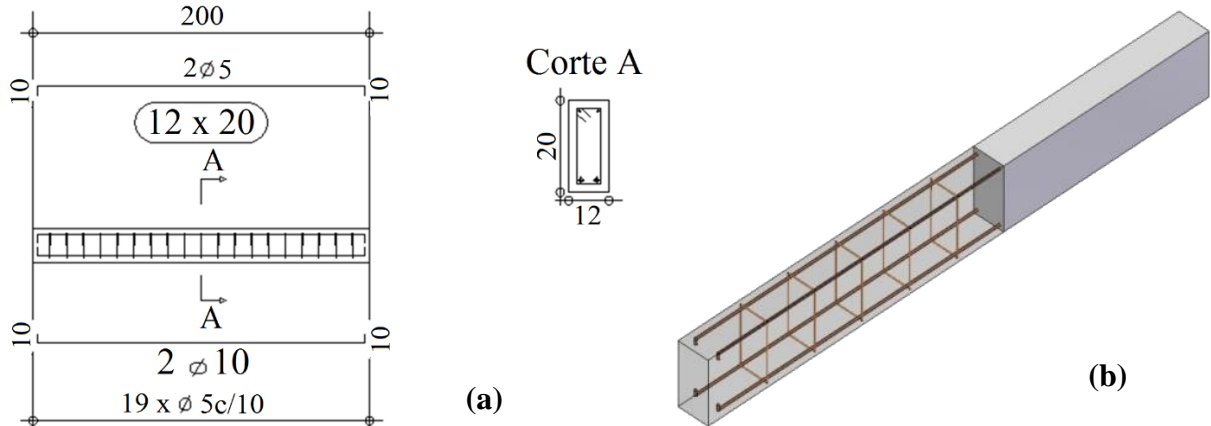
Detalle de las armaduras en las vigas - (a) Detalle longitudinal; (b) Perspectiva del armado
